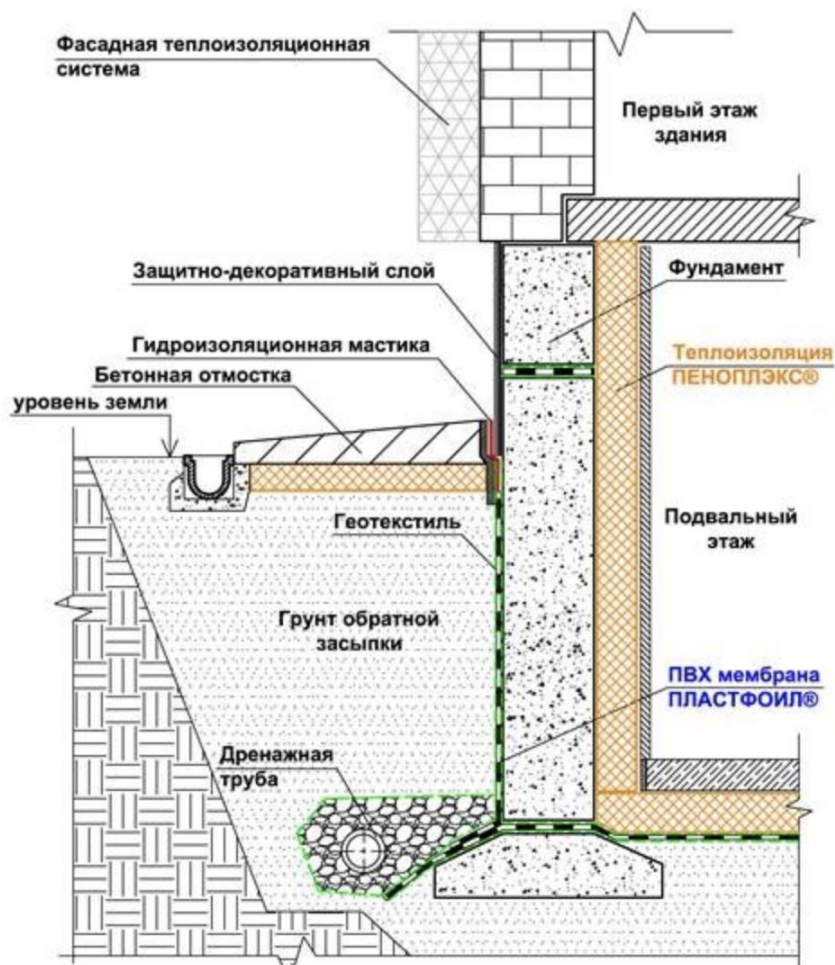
Принципова схема влаштування теплоізованих фундаментів підвалів (теплова ізоляція з внутрішнього боку).
